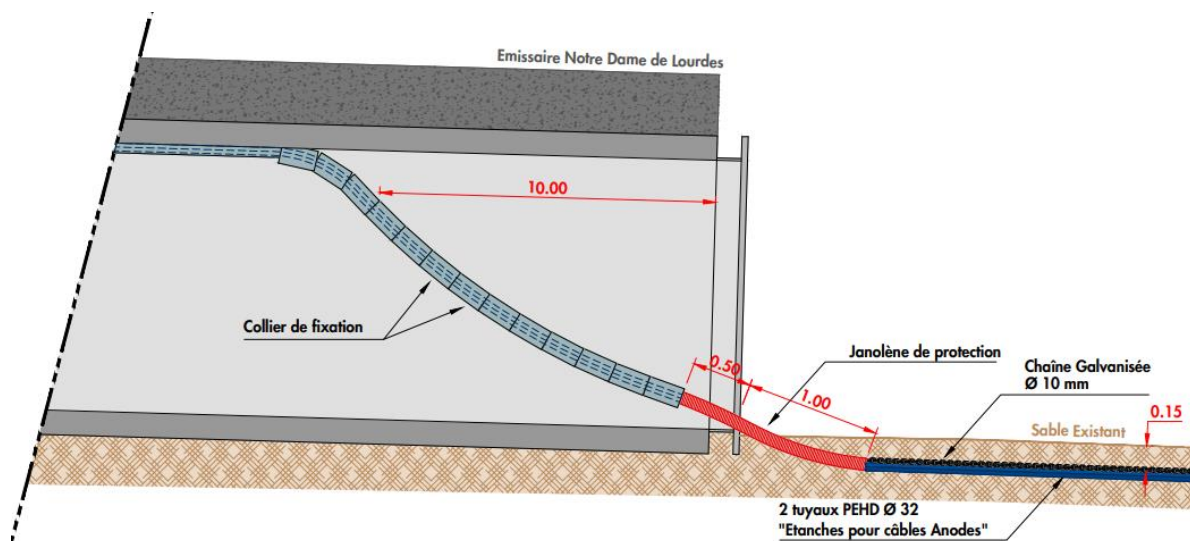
Détail enfouissement (extrait plans annexe n°6)
